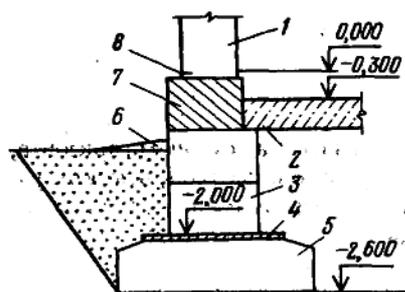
Подвальная часть здания: 1 – стена; 2 – плита перекрытия; 3 – блоки стен подвала; 4 – гидроизоляция; 5 – фундамент; 6 – отмостка; 7 – цоколь; 8 – риска нулевого горизонта
